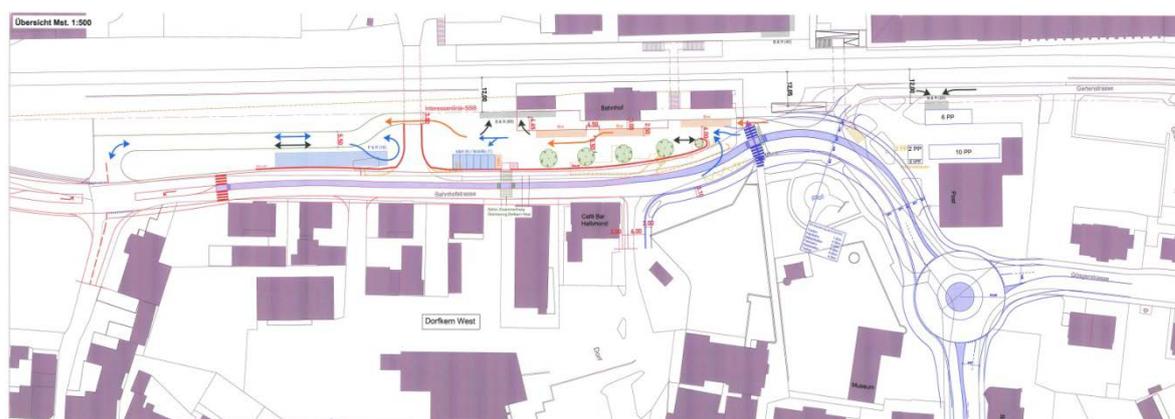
Betriebskonzept Variante 3 (Kontextplan, Übersichtsplan 1.10.2010)
